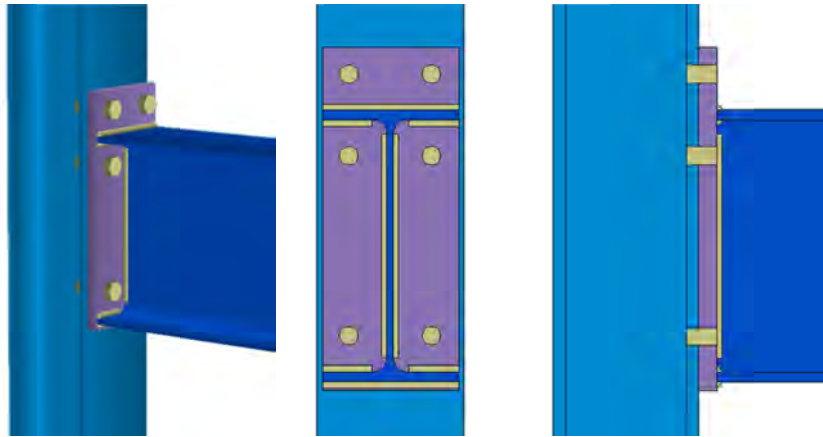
Unión viga-columna con chapa de testa atornillada a una columna continua y sin rigidizar.
